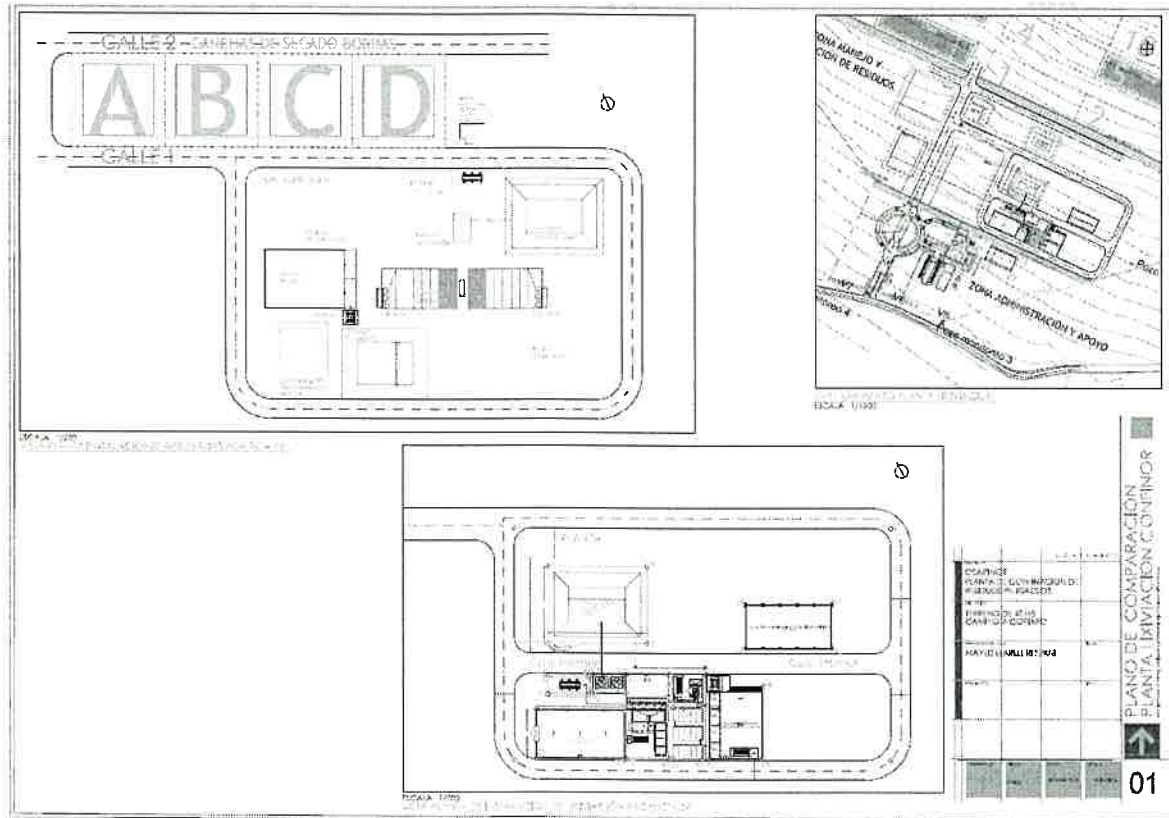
Vista de distribución de instalaciones aprobada por RCA N° 181/2008 y vista situación Proyectada.
